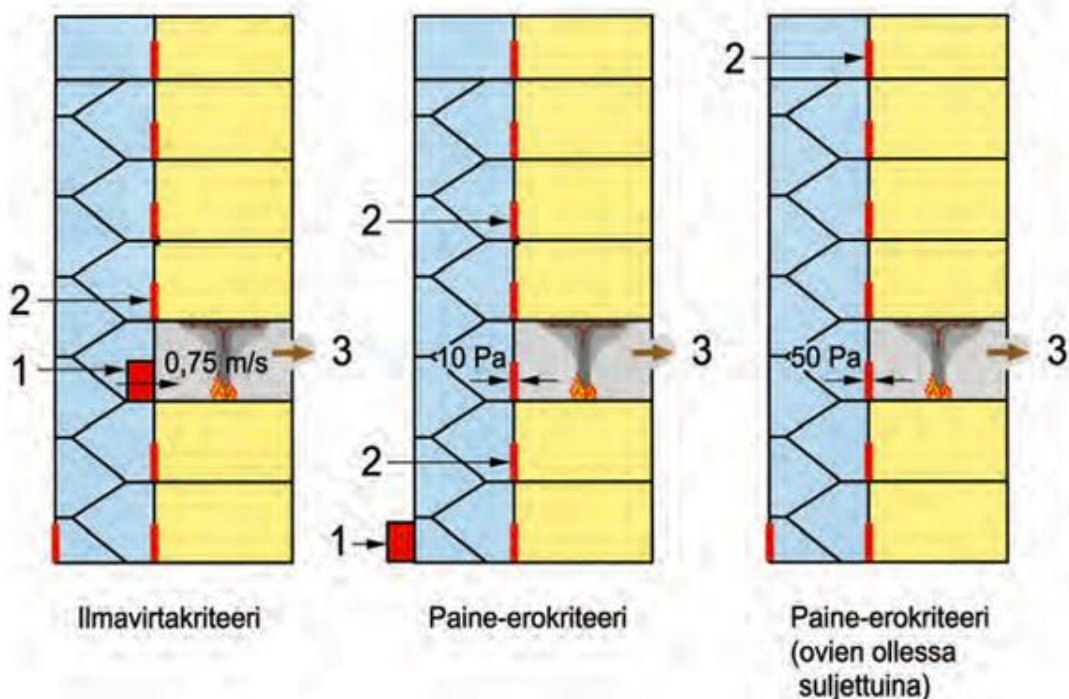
Järjestelmän toiminta savunpoiston tilanteessa. (Fläkt Woods 2008, 5).
